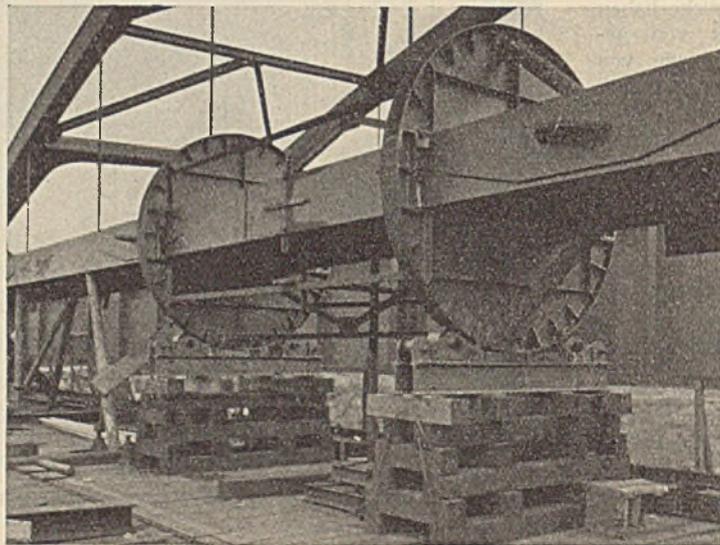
In eine Drehvorrichtung auf der Baustelle eingespannter, zu verschweißender Träger.
